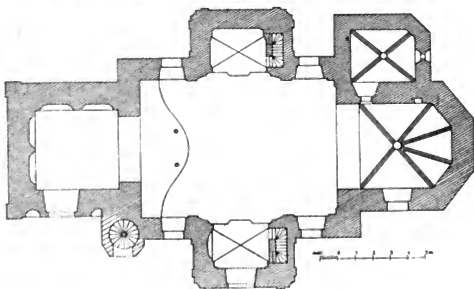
Strážitz. Grundriss der Kirche.
